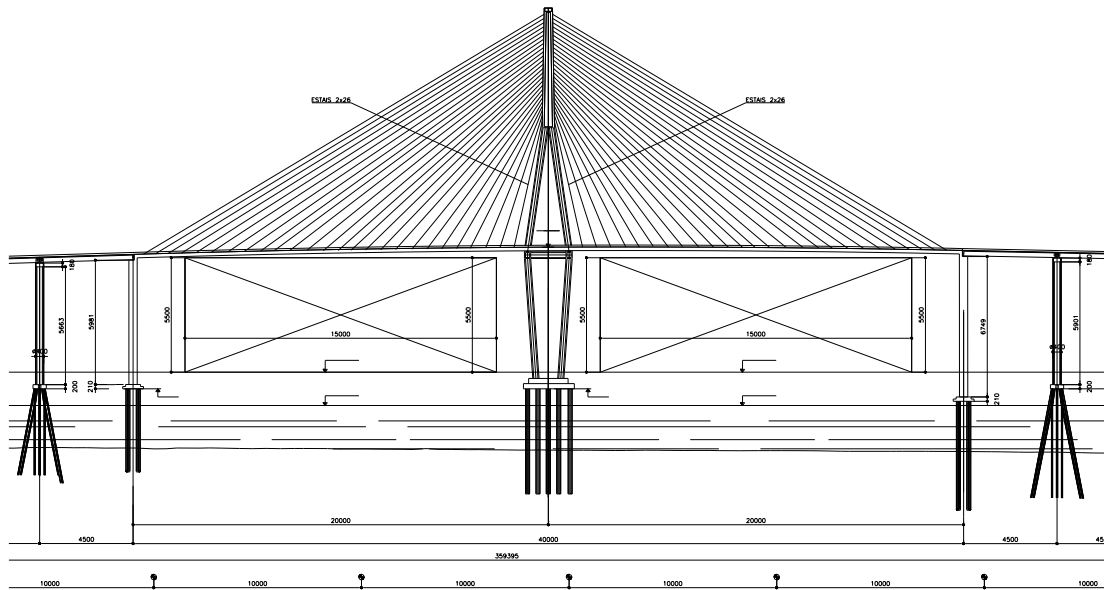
Detalhe da parte estaiada e visão transversal da torre central.
